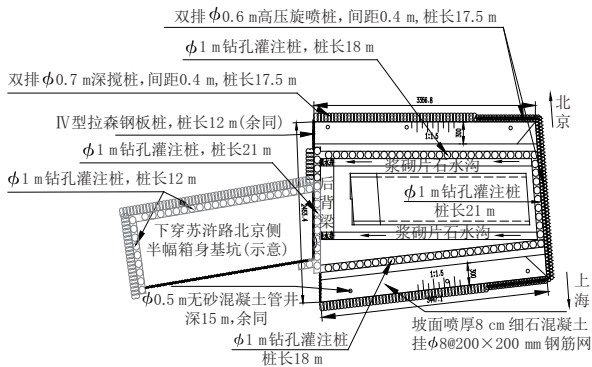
北京侧箱涵顶进基坑平面布置图(单位:mm)
